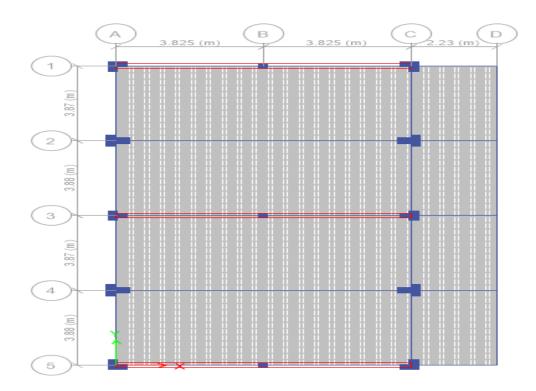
Modelado de las columnas "T" y "L"- vista en planta
